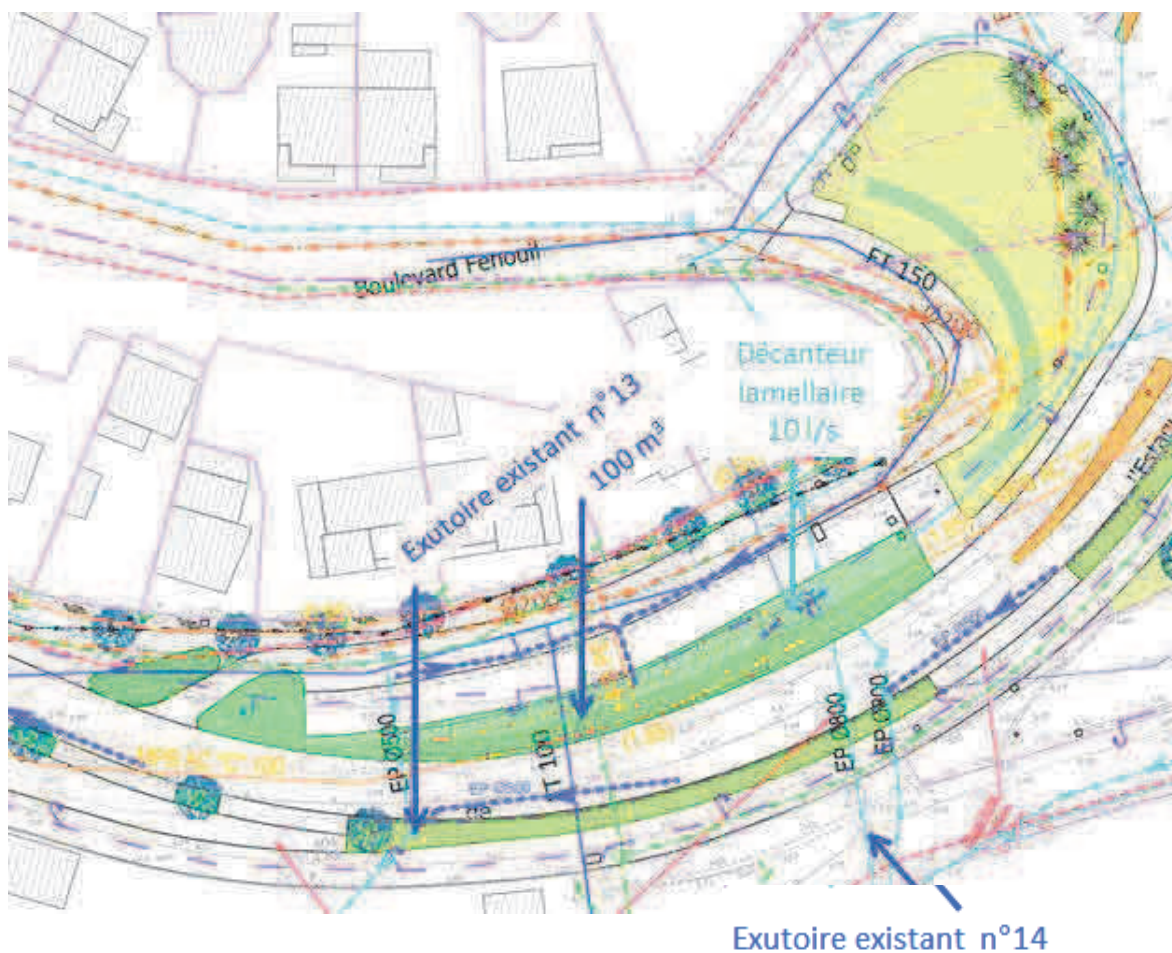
Plan du système de gestion des eaux pluviales sur le parking P2
